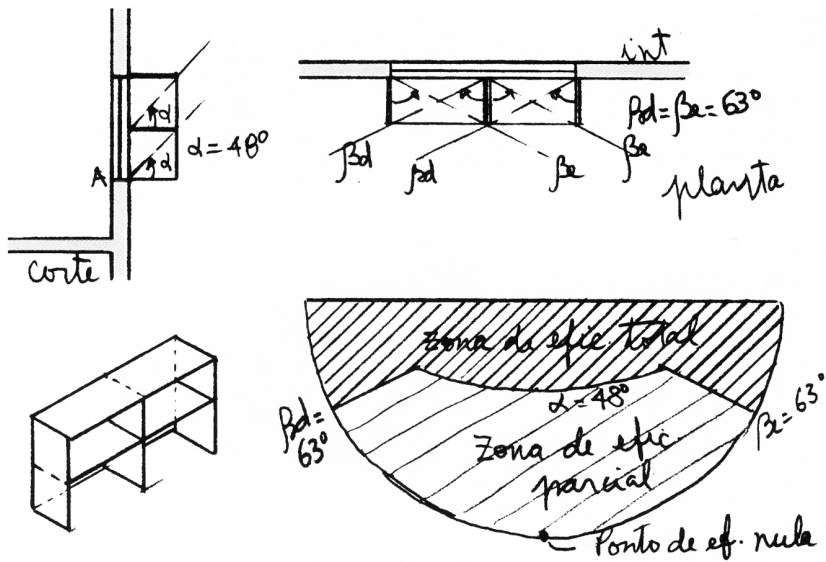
Máscara produzida por dispositivo de proteção solar, composto de placas verticais e horizontais.
